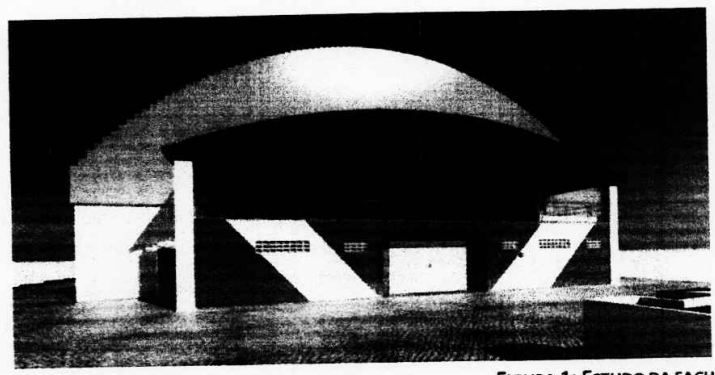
ESTUDO DA FACHADA (MAQUETE)
